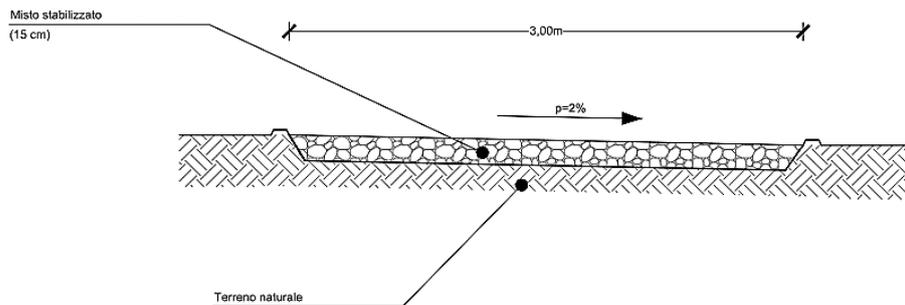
Sezione tipo strade interne al sito di progetto (Fonte: ns elaborazione)
